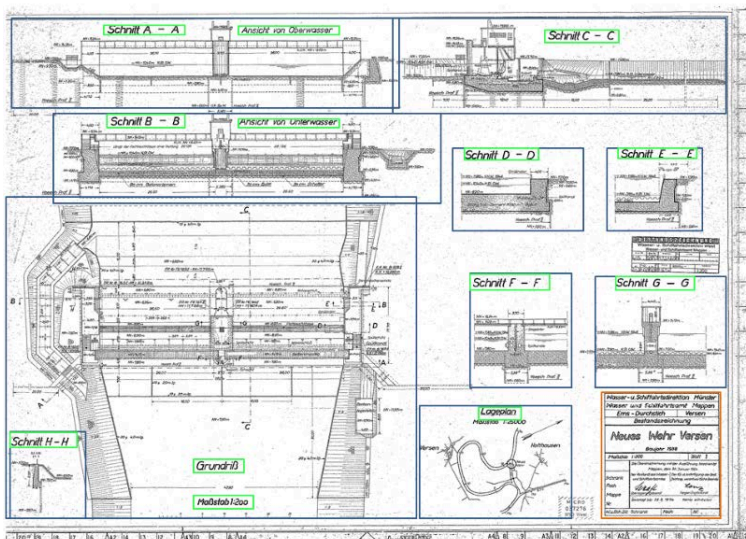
Ein Übersichtsplan, der zentrale Pläne wie Grundriss, Ansichten und Längsschnitt zusammenfasst. Erkannt sind Pläne (Blau), Text (Grün) und das Textfeld (Orange).
